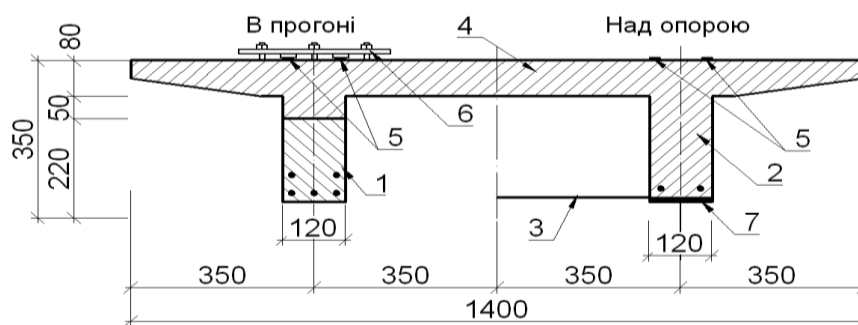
Поперечні розрізи дослідної конструкції: 1 – збірна прогонова балка, 2 – надопорна монолітна балки, 3 – монолітна поперечна балка, 4 – монолітна плита, 5 – надопорна неметалева стрічкова арматура Sika Carbodur S212, 6 - анкерна деталь для кріплення стрічкової над опорної арматури; 7-зовнішня листова арматура стиснутої зони на опорах
